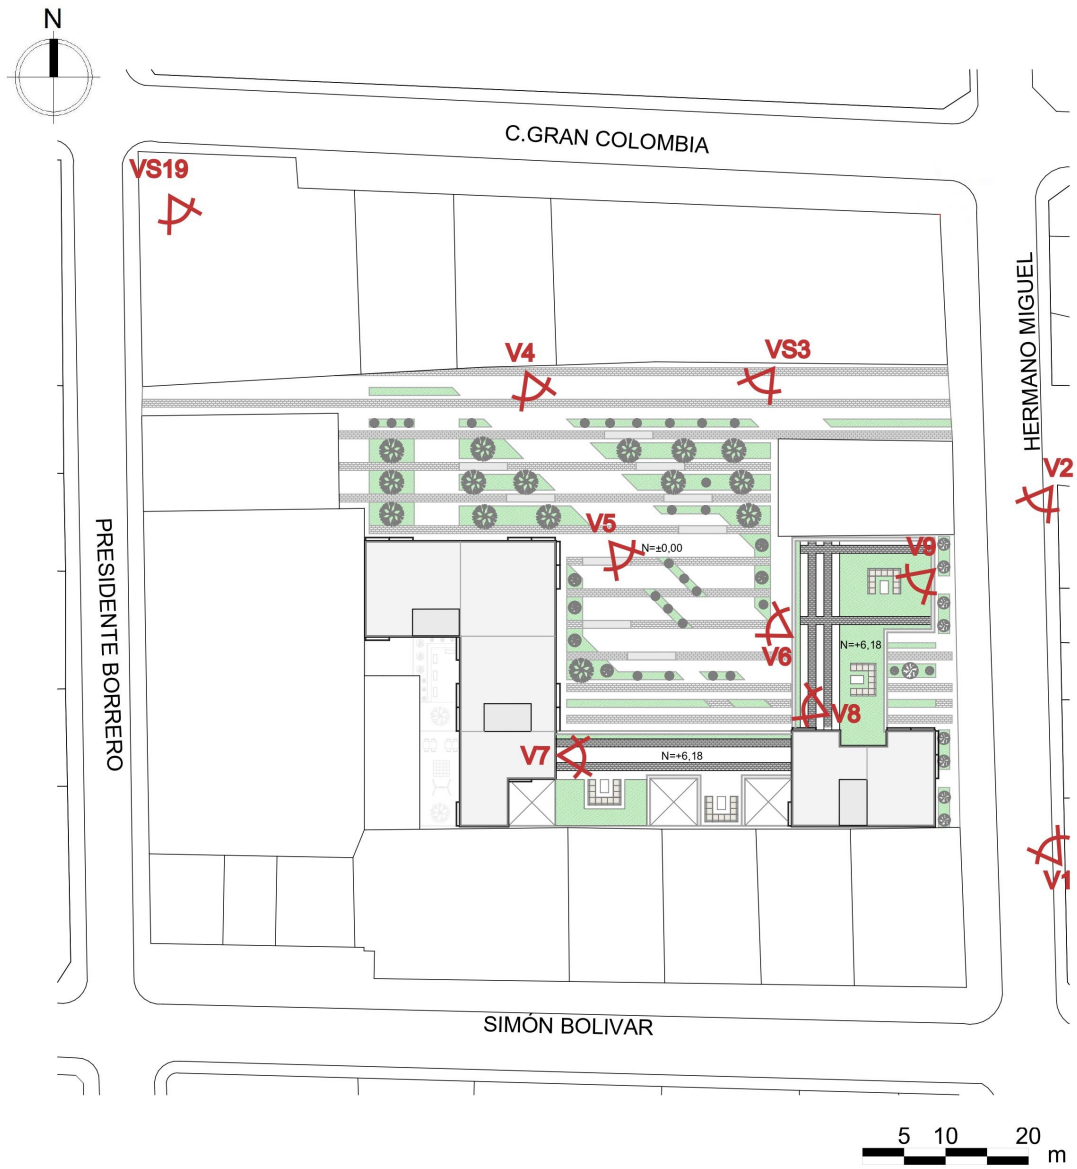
Plano que indica las vistas de la propuesta. Fuente y elaboración: Autores
